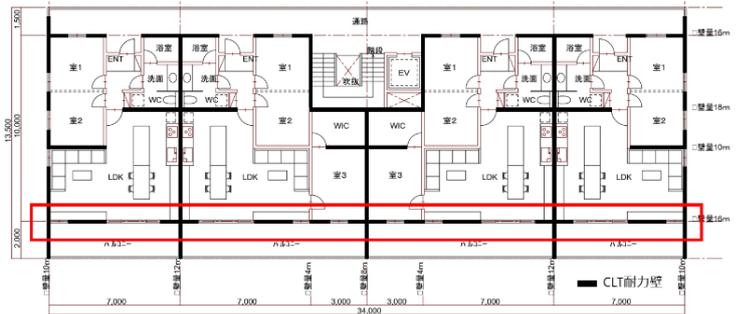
4階集合住宅平面図(赤枠が検討フレーム)
